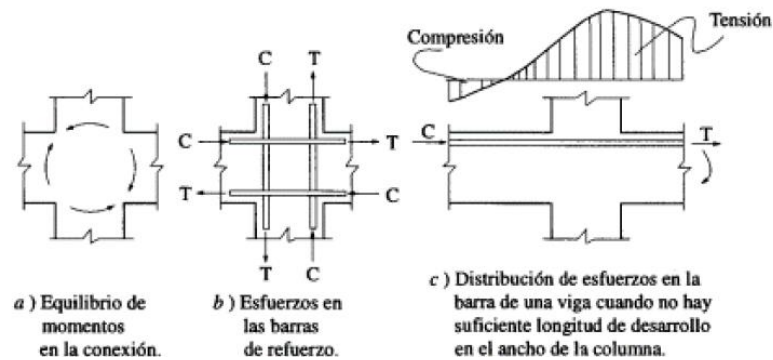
Unión viga columna [Bazan & Meli,1985]
